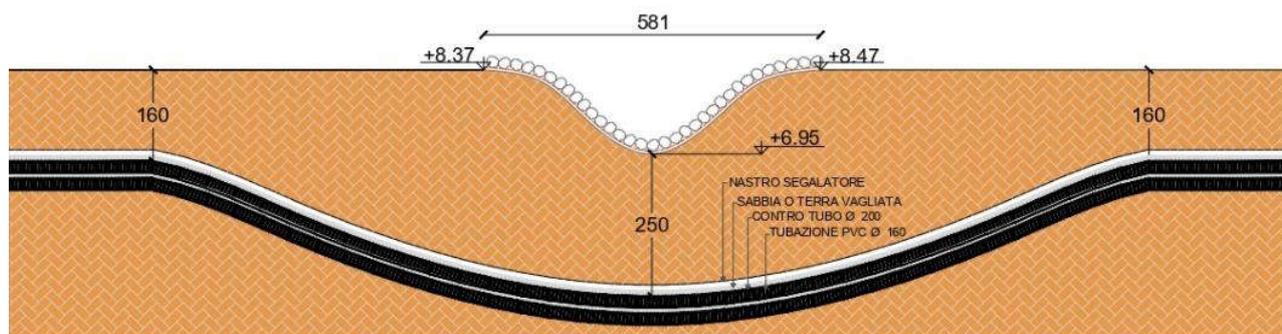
Sezione tipo dell’attraversamento del canale di scolo
